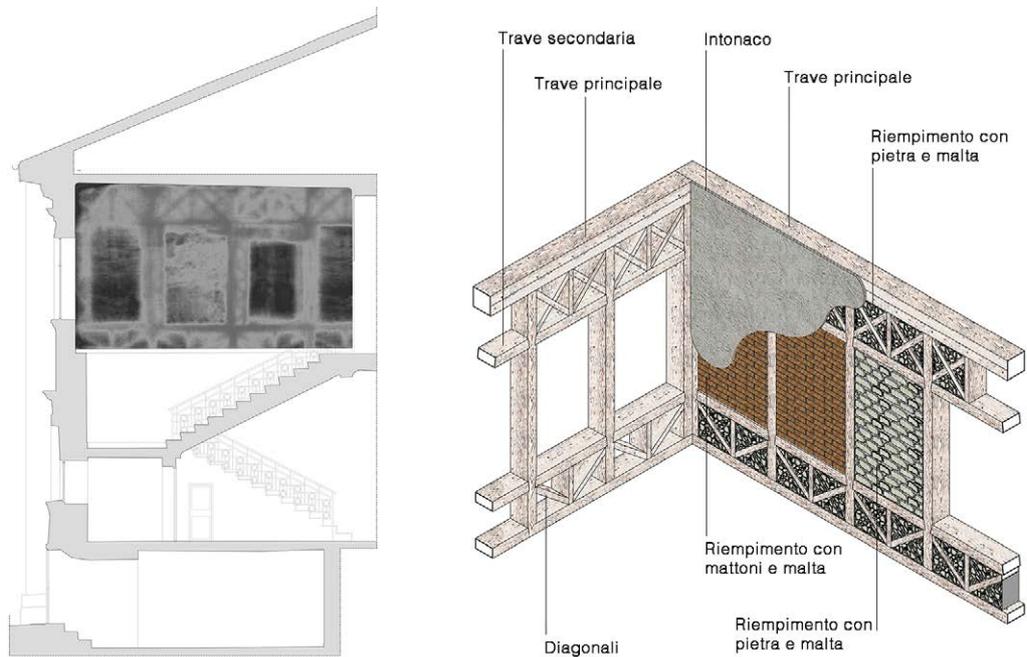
Tradizionale struttura a telaio ligneo rilevata dalla termocamera al di sotto dell'intonaco della controfacciata sul vano scale. Elaborazione di CHM\_lab, Albi Ballgini.
